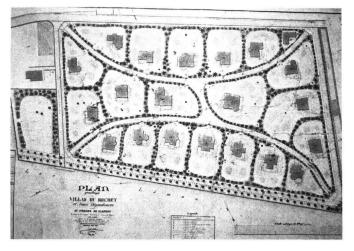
Plan du lotissement des villas Dubochet à Clarens.
